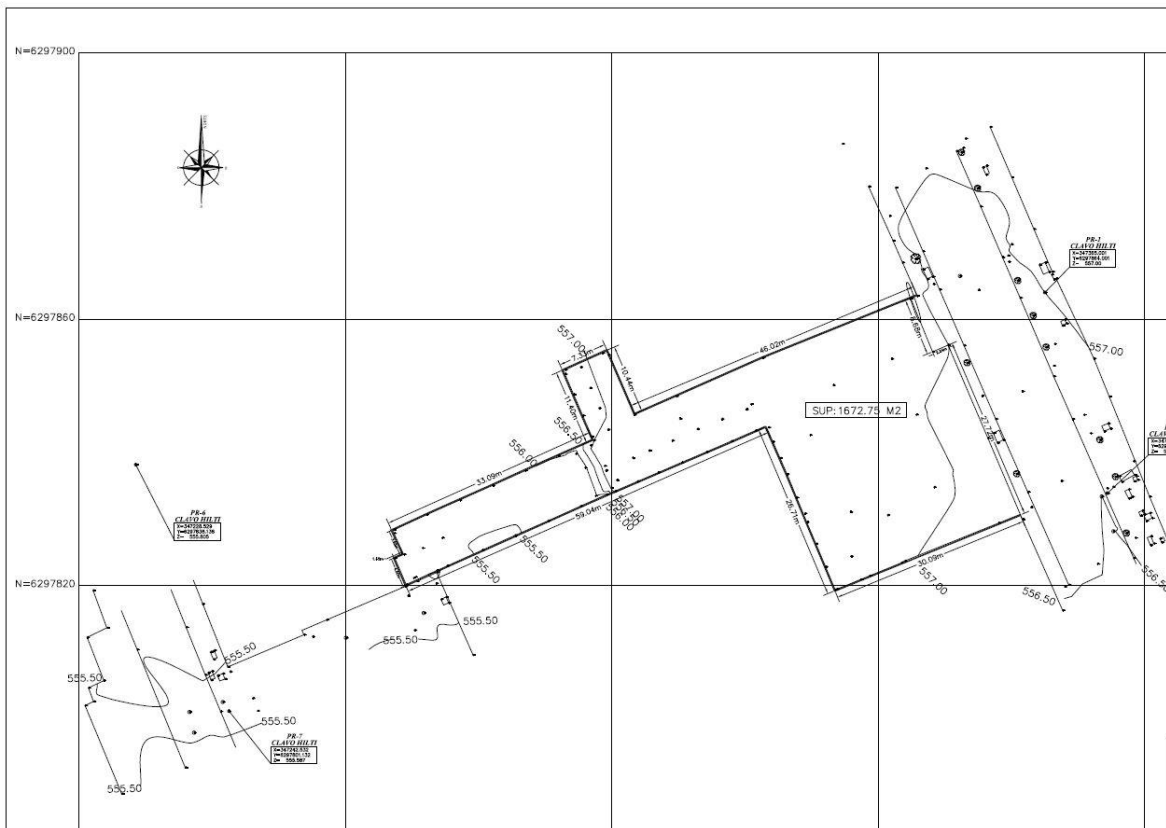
Plano de levantamiento topográfico desarrollado por la empresa ABB topografía. Imagen extraída de archivo en formato Cad.
